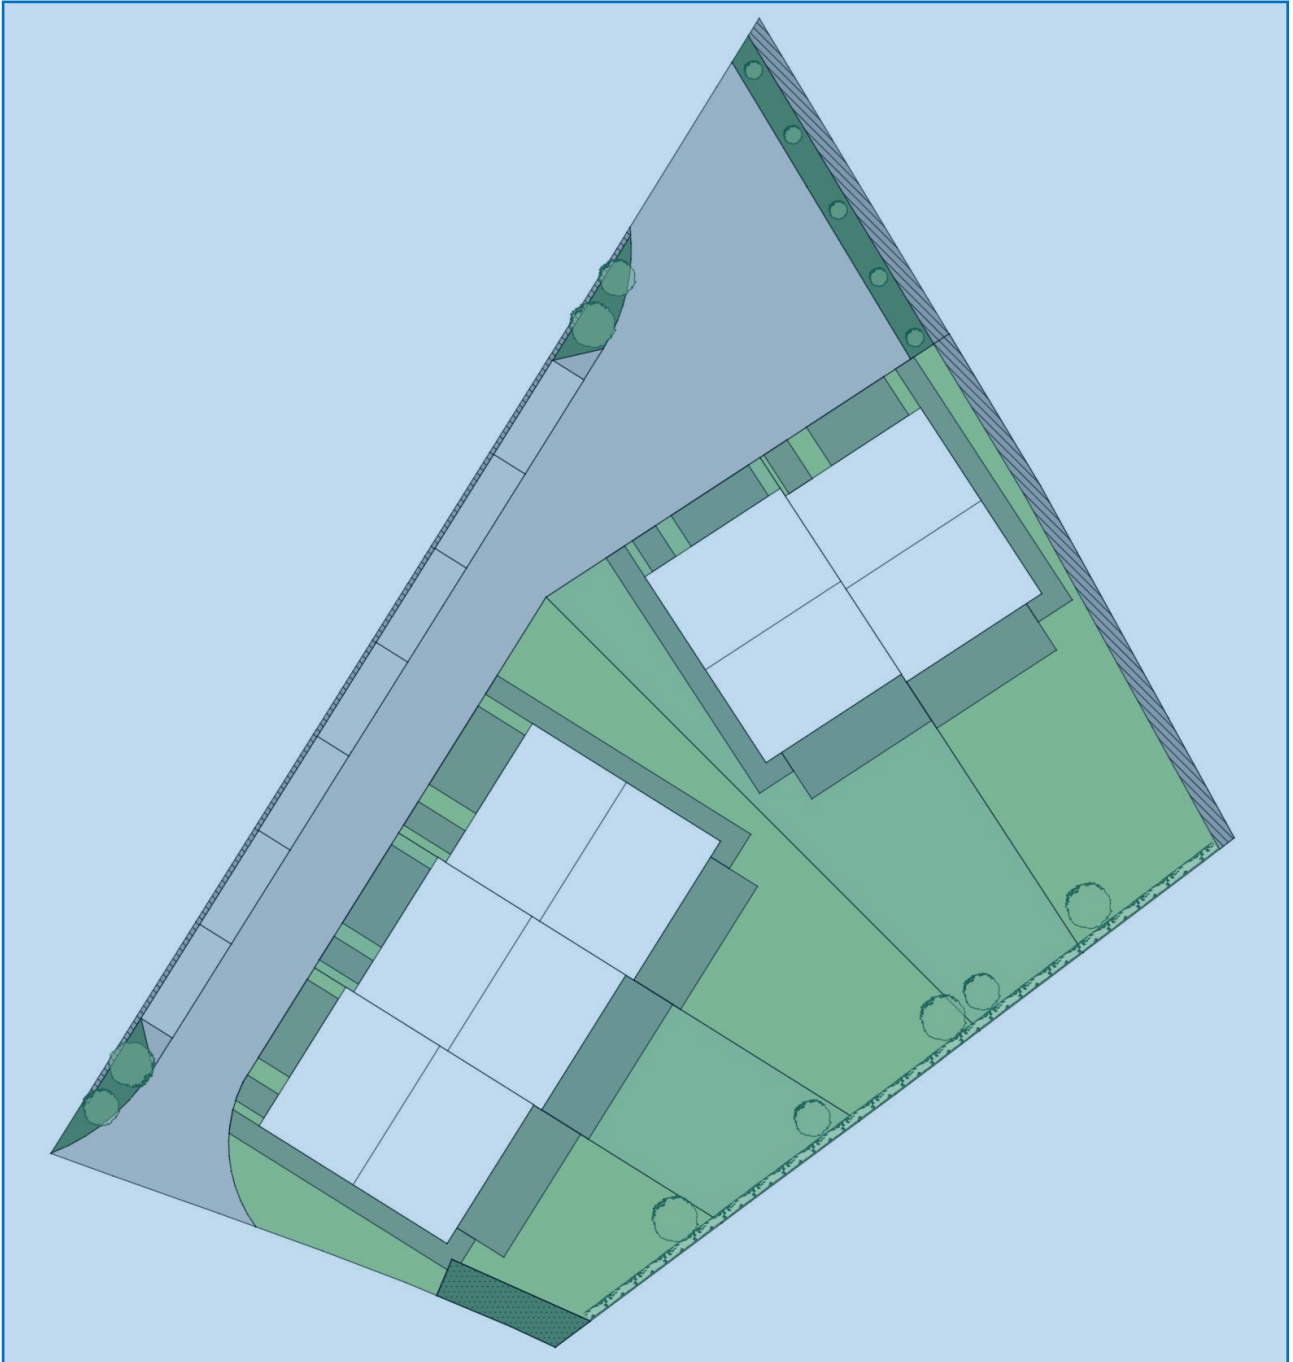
Schwarzplan existierende und geplante Bebauung
